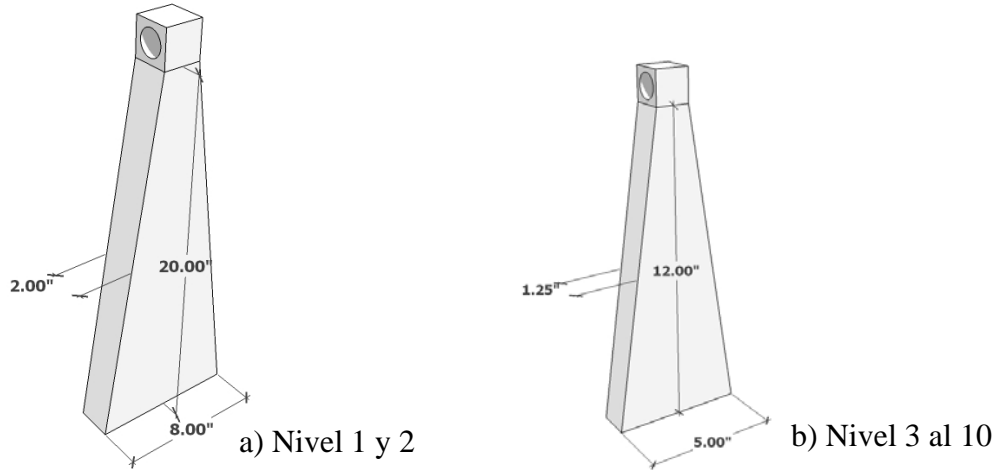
Placas tipo TADAS y dimensiones propuestas
